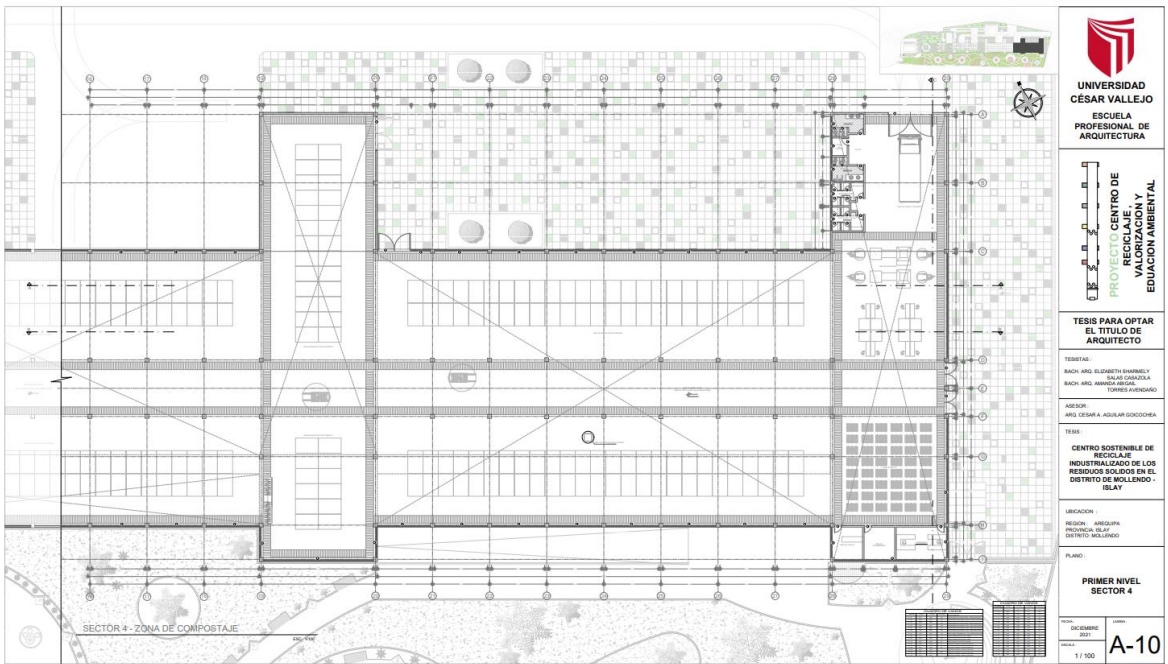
Planta de Distribución, Sector 4 – Primer Nivel
